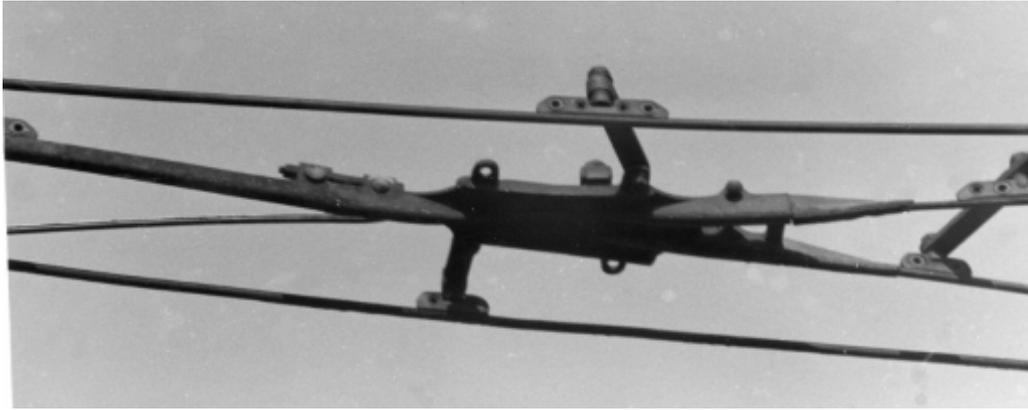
C (v. Messina diramazione per cantiere armamento - morsetti 4.2 sul filo di contatto, 4.3 sulla slitta)
